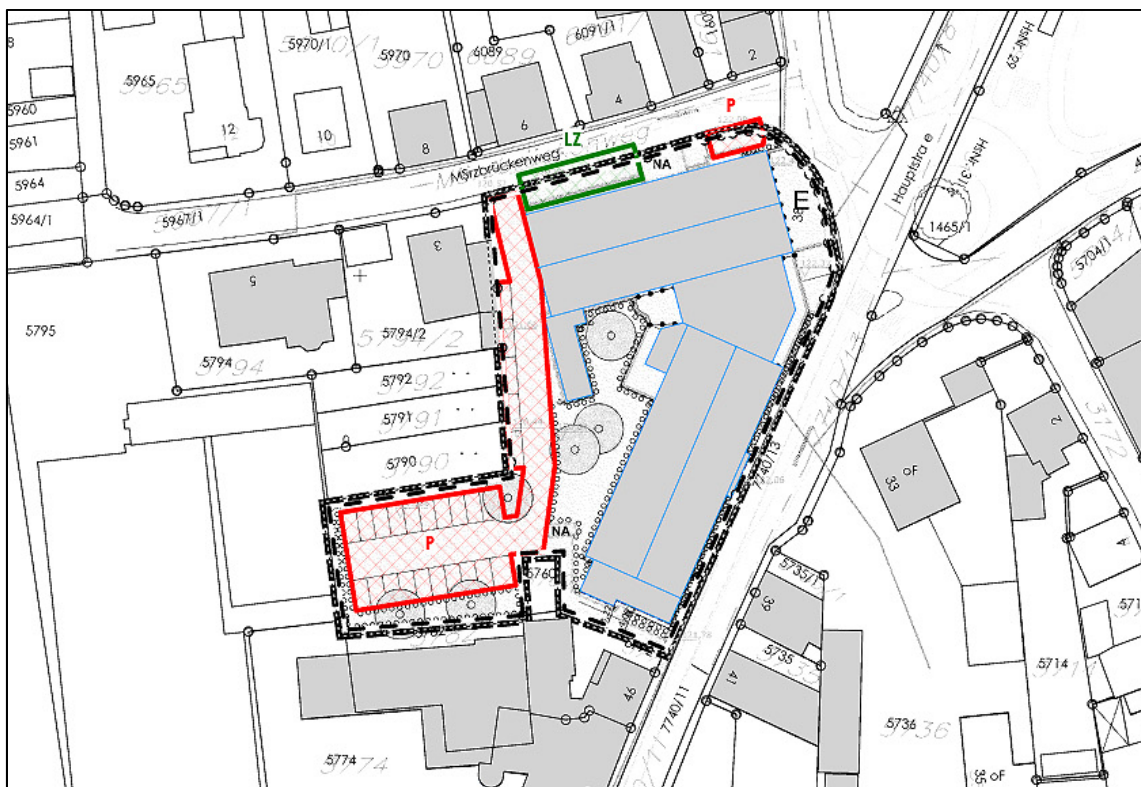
Lageplan mit Darstellung der Schallquellen
